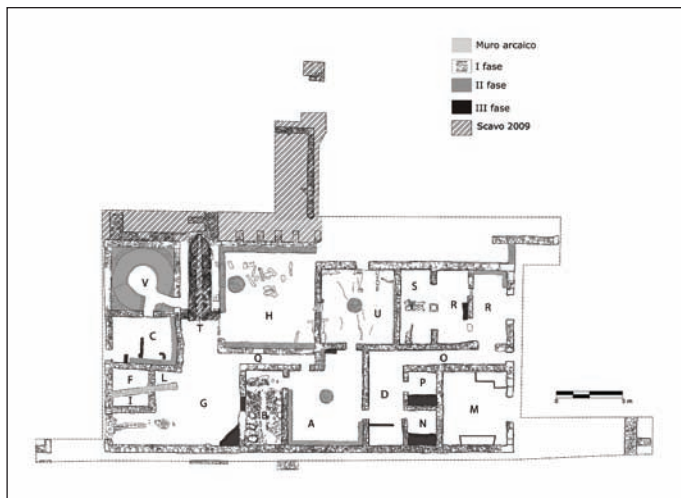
Pianta delle strutture delle terme ellenistiche.
